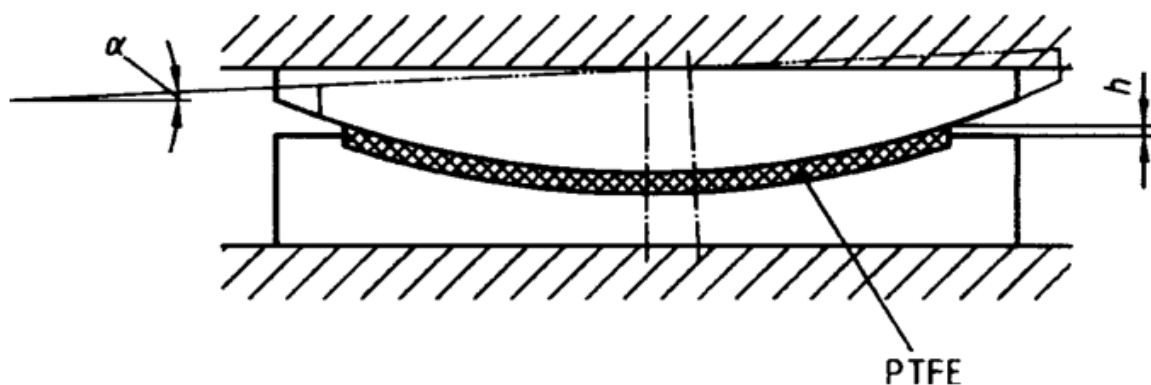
Kontrola obrotu tłoka łożyska garnkowego, według [10]
